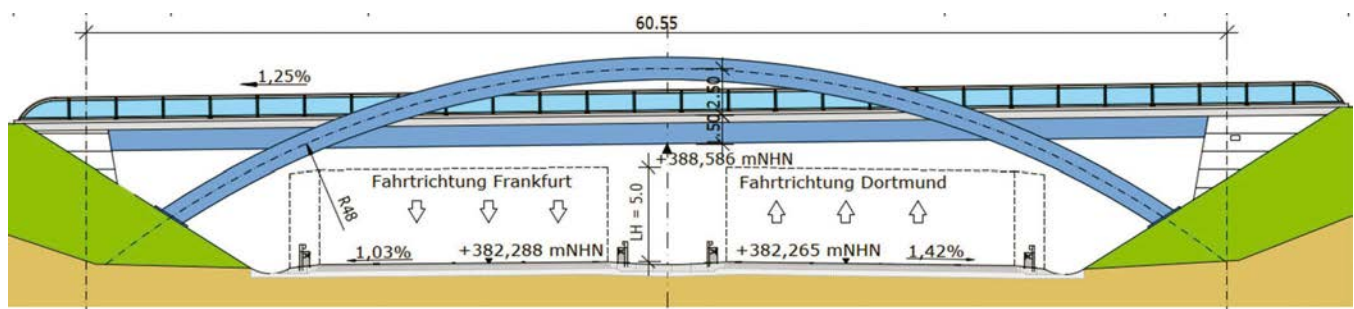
Variante 3 – Stabbogen mit Stahlverbund-Überbau
